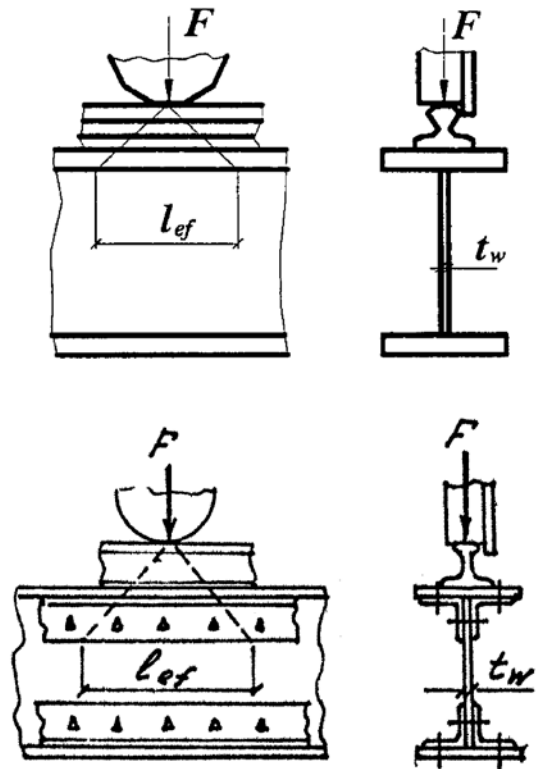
Схема розподілення зосередженого навантаження на стінку балки.
